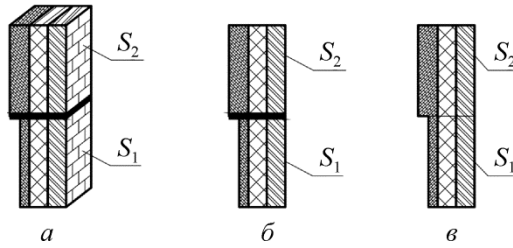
Горизонтальный стык: *а* – узел конструкции; *б* – расчетная модель узла конструкции с теплопроводным включением; *в* – расчетная модель узла конструкции той же суммарной площади без теплопроводного включения
